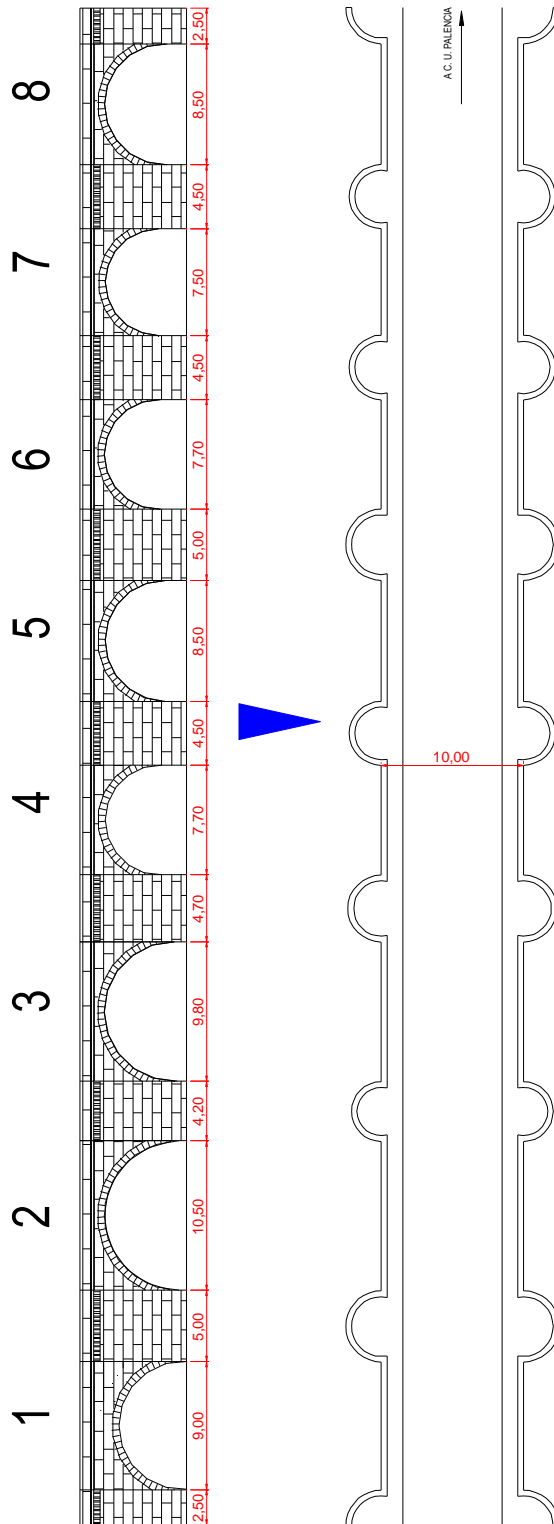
Planta y alzado de aguas abajo del puente Mayor
